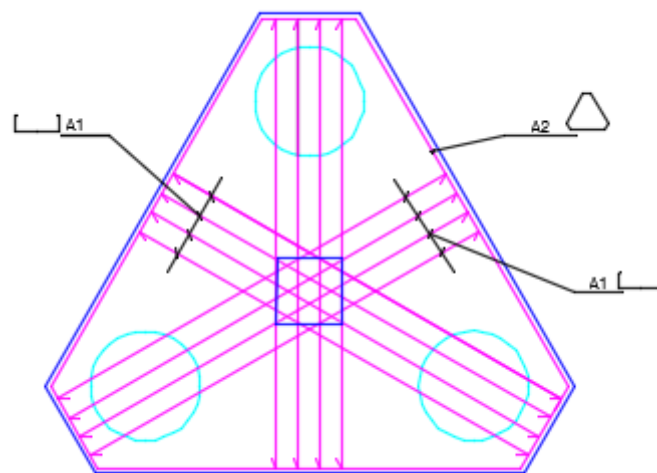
Armaduras com disposição mista. (Pouca, 2016)
